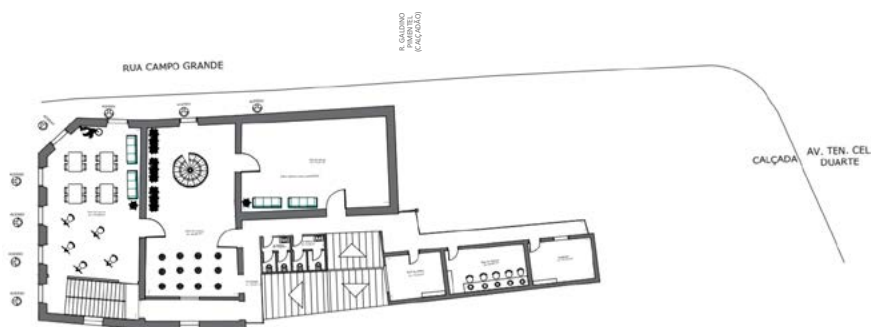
Planta Baixa Humanizada 1º Pavimento
